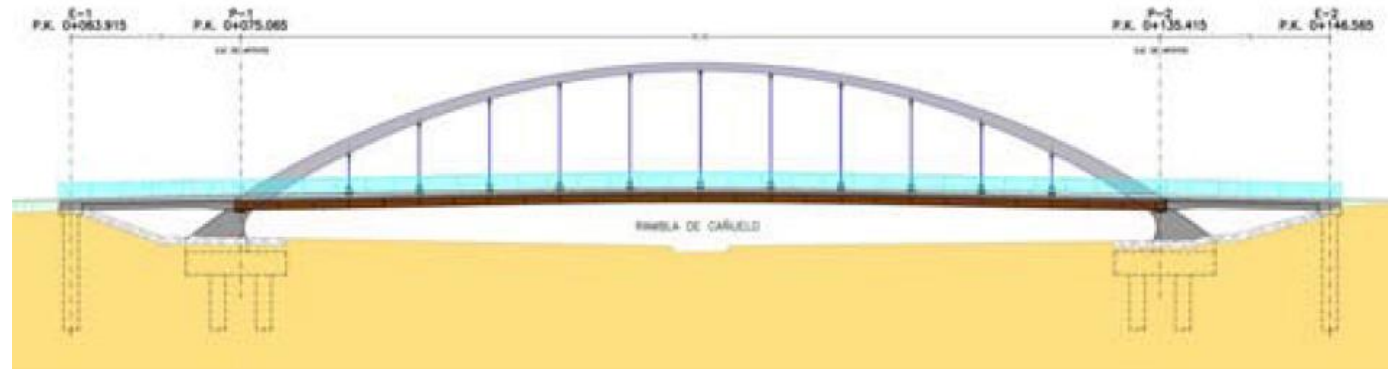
Alzado del puente arco sobre la Rambla del Cañuelo [Jorquera 2005]
